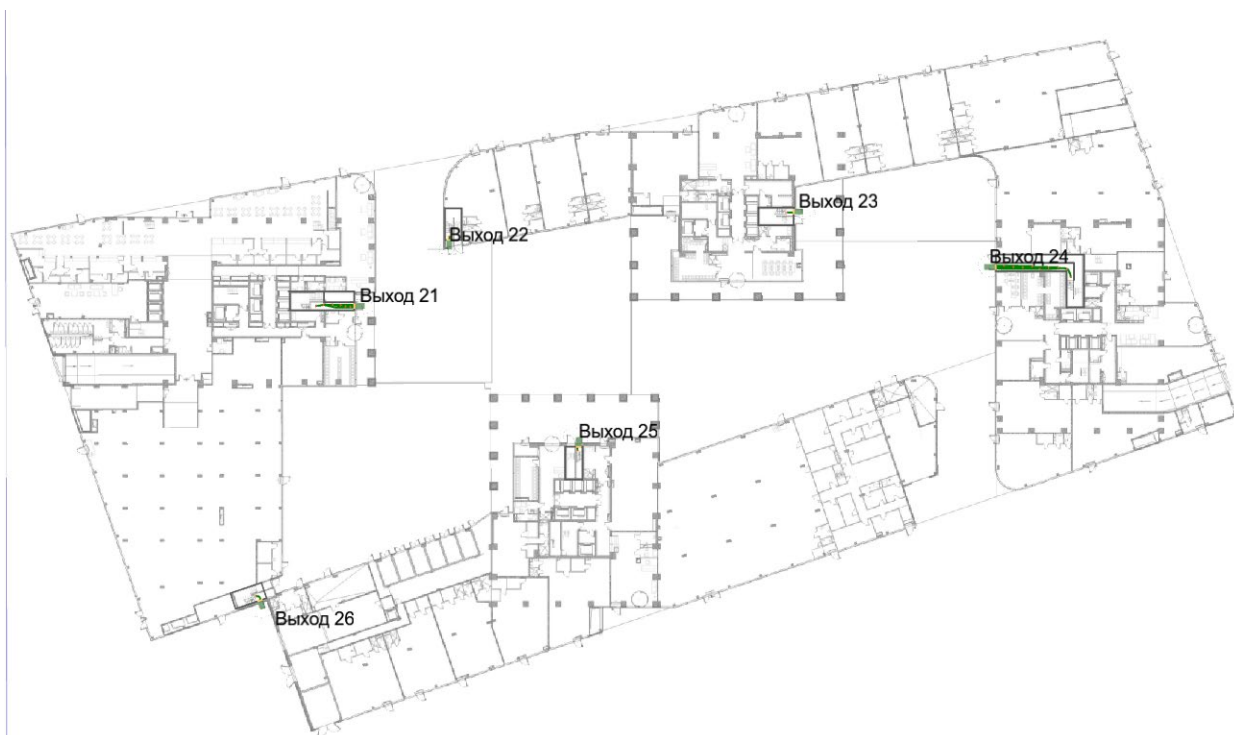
План 1-го этажа и нанесенная на него расчетная (принципиальная) схема эвакуации
